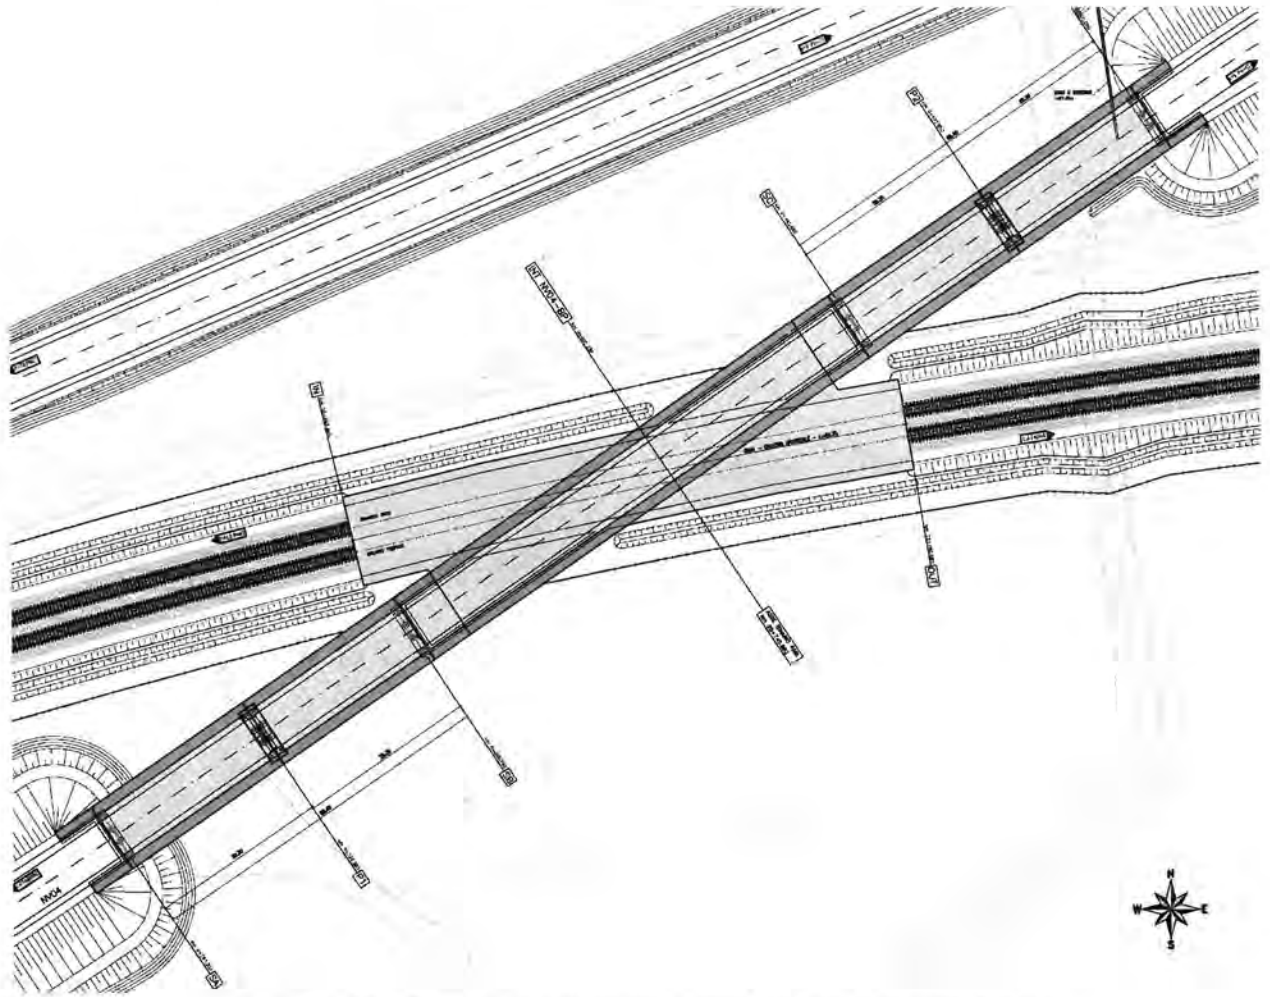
Planimetria sottopasso scatolare e relativo cavalcavia
